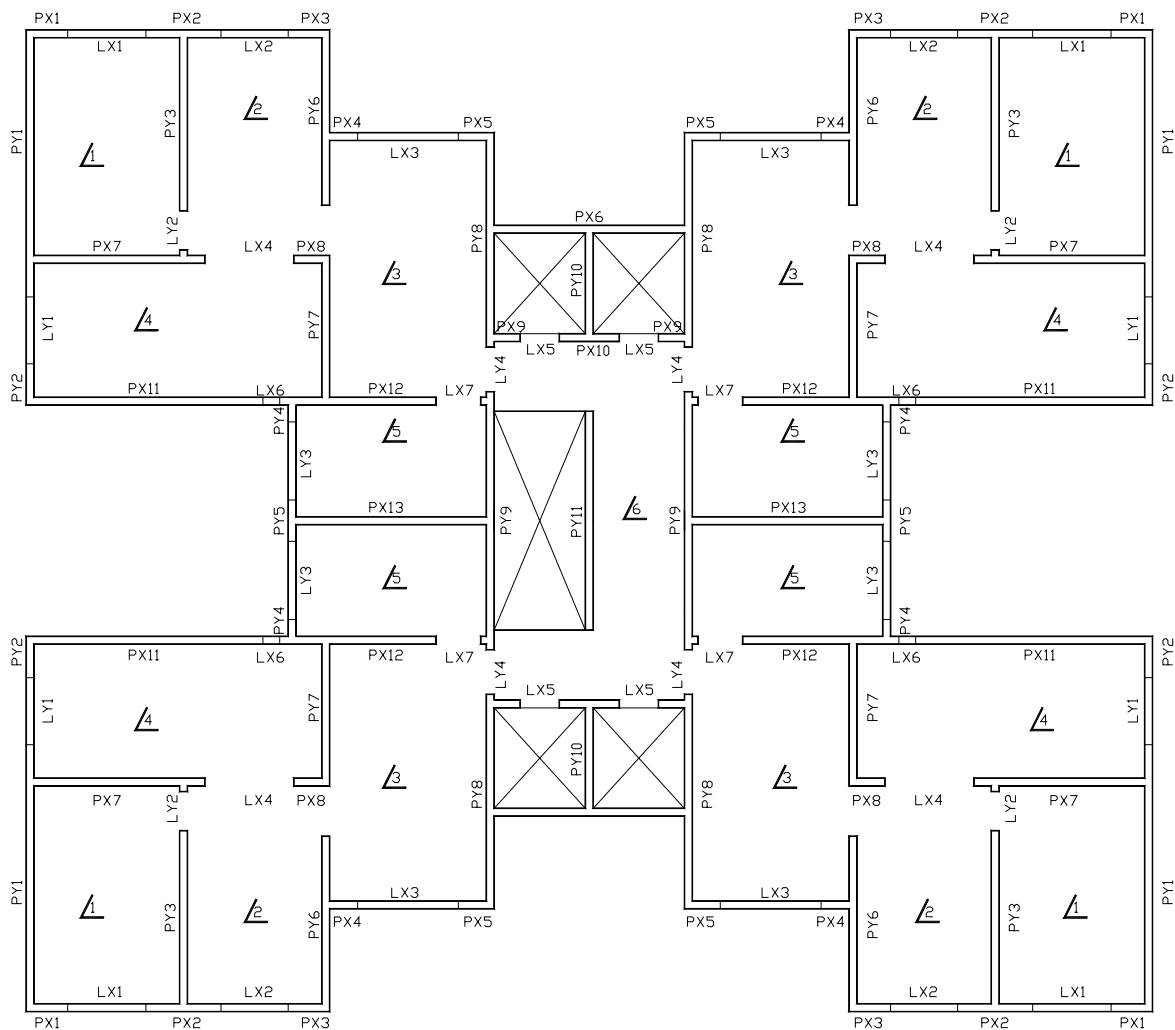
Formas do pavimento tipo com numeração das paredes e dos lintéis
